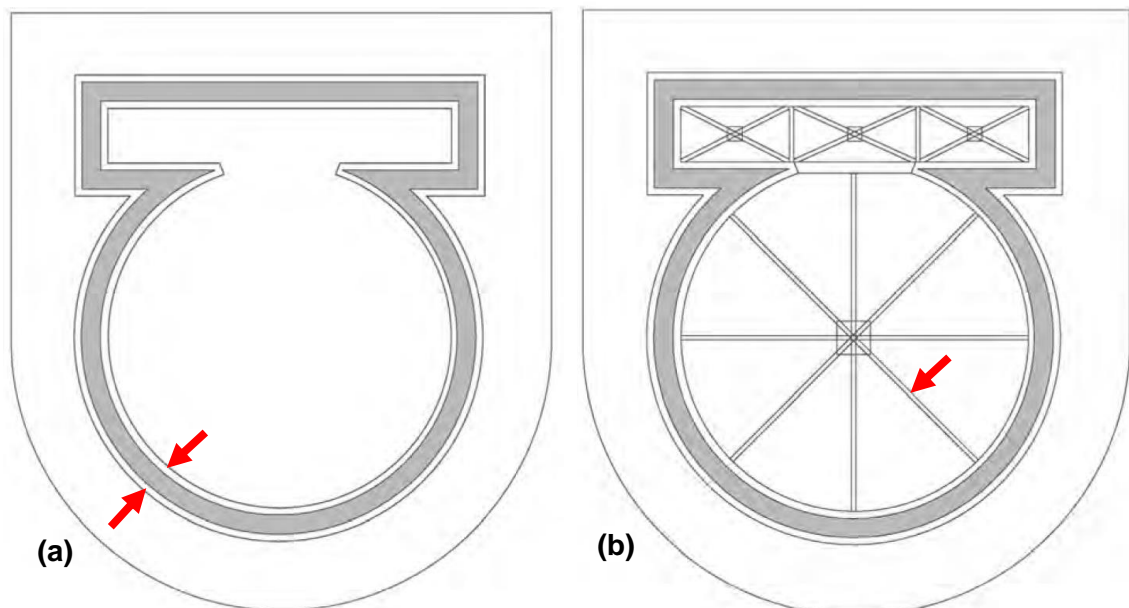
Pianta dell'edificio. (a) Posa delle carpenterie metalliche a formare l'affiancamento murario; (b) installazione delle controventature in acciaio IPE180 - Moussalli (2014).
